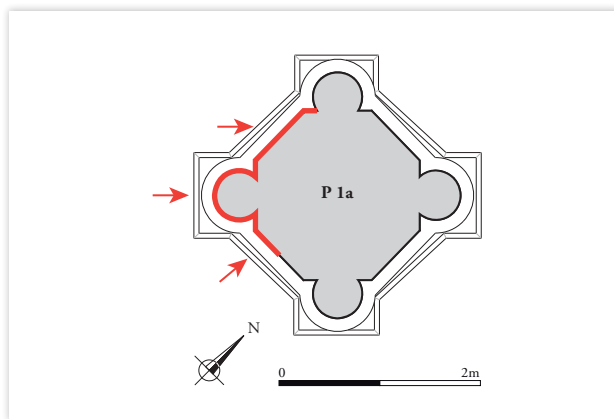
Plan du pilier P 1a, localisation de l'enduit UE 22 – échelle : 1/75.
